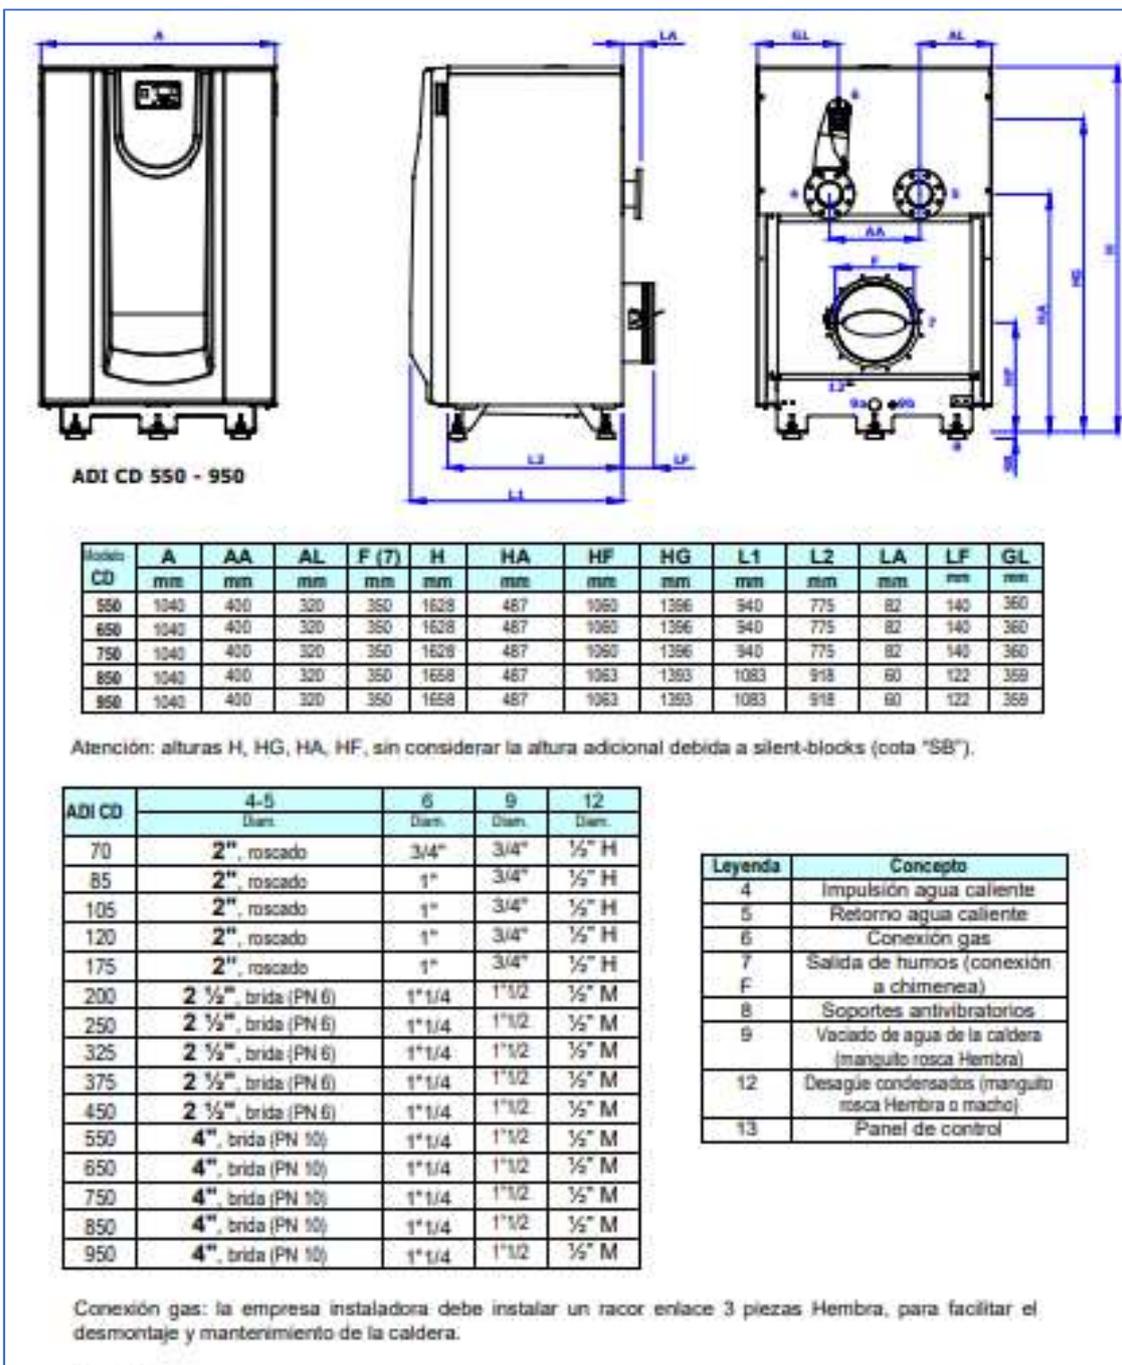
Detalles constructivos caldera – catálogo ADISA
